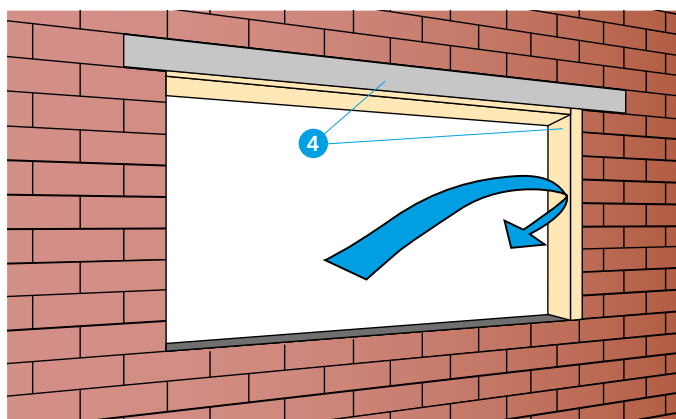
Detail A - příklad provedení obkladu deskou PROMASIL®-KP v místě tepelného mostu
